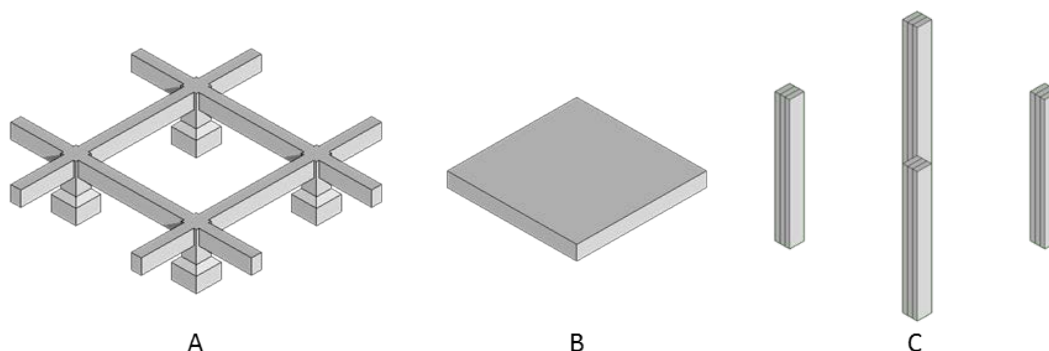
Imagem dos componentes de fundação. Reticulado em betão armado (A), Laje em betão armado (B) e Estacas de madeira (C).
